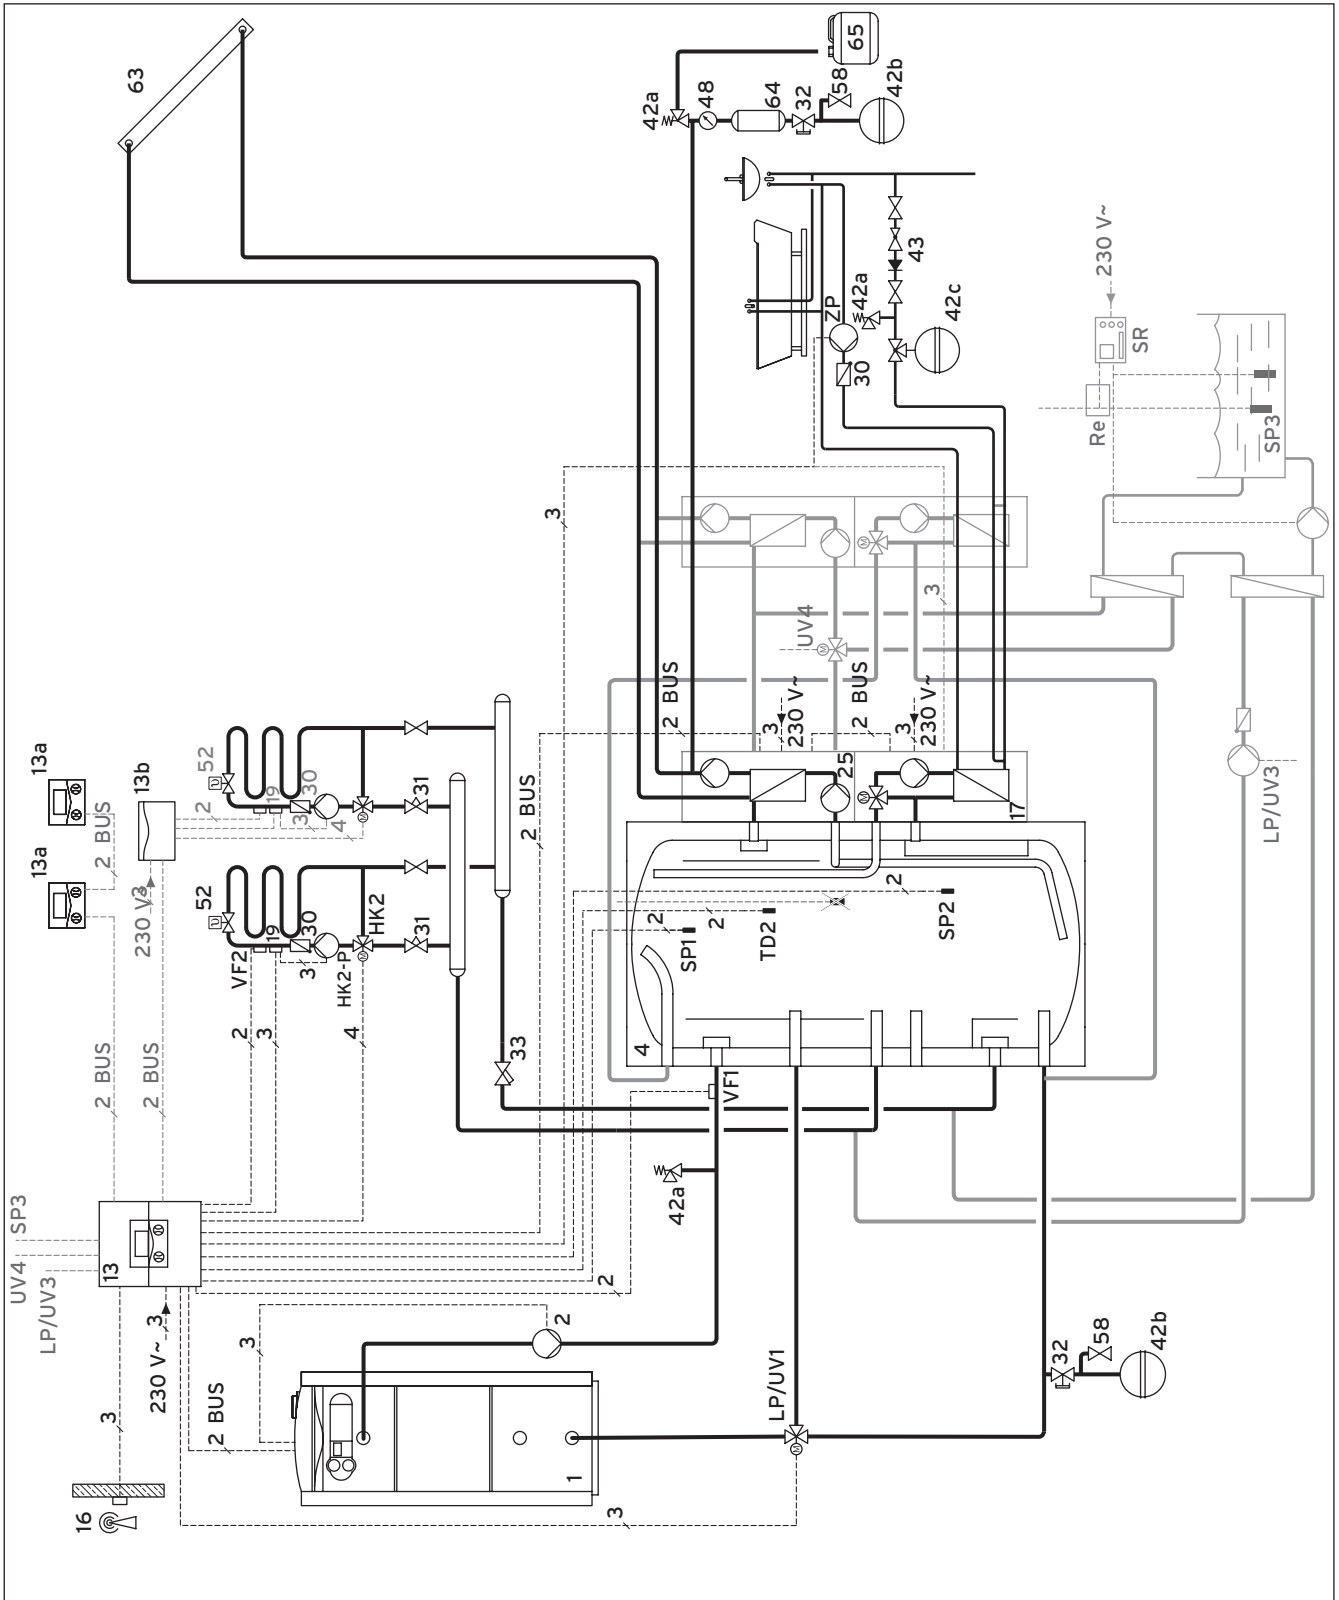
Schema di collegamento caldaia a gas a cond. ecoVIT
